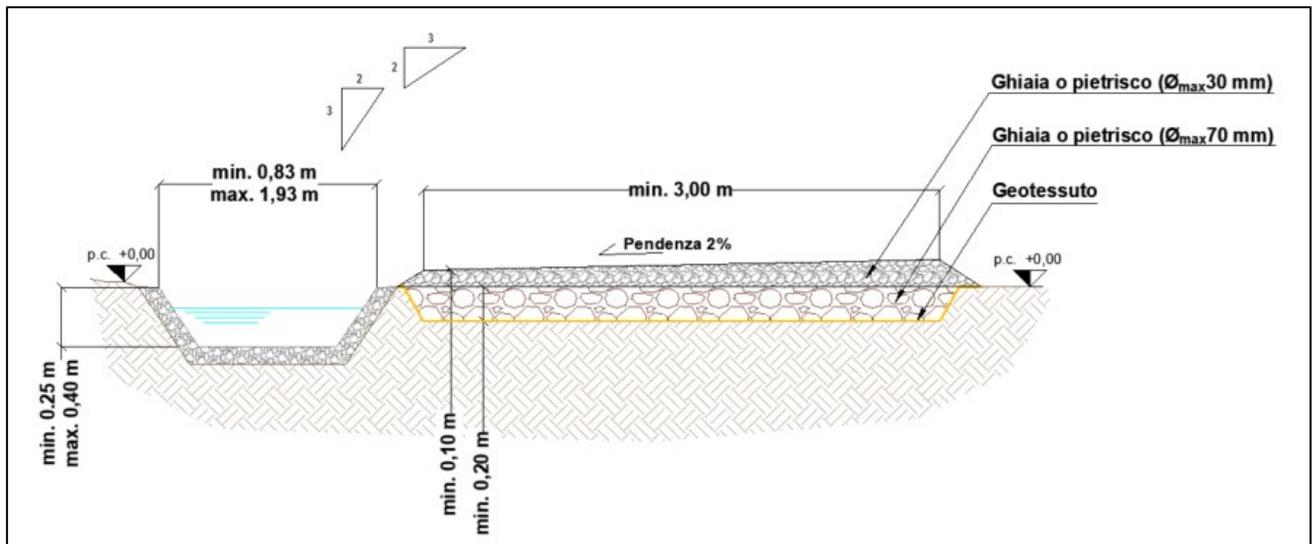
Tipologico sezione stradale viabilità interna con canaletta di drenaggio.
